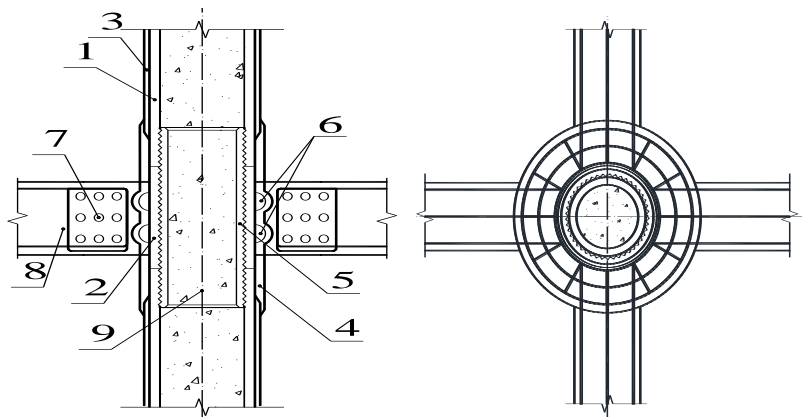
内衬筒钢筋混凝土梁节点
